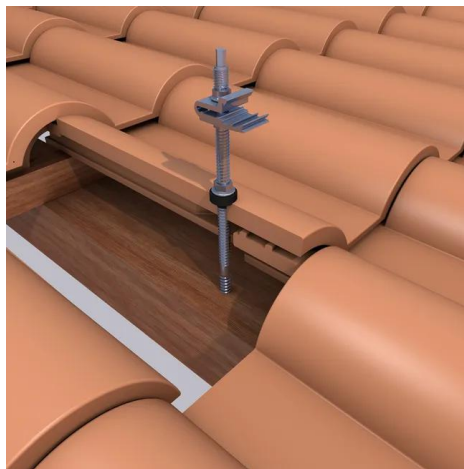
Perfuração diretamente sobre a telha até ao barrote de madeira [49]
